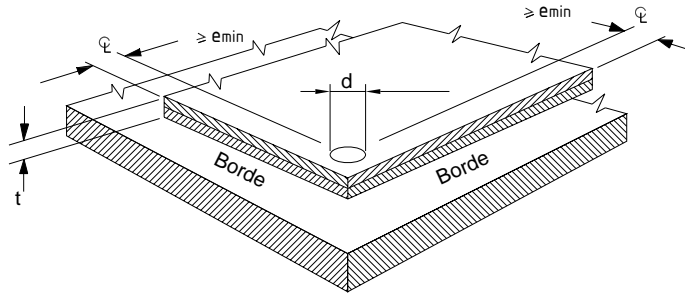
Distancia de Borde para Puntos de soldadura por arco – Plancha Doble
